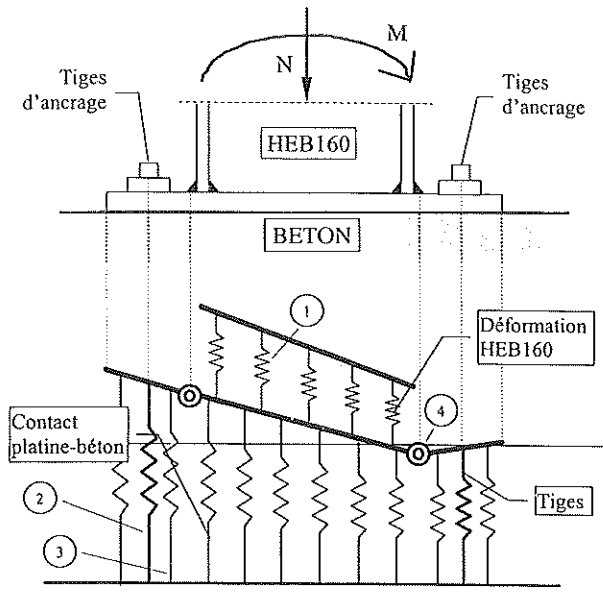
Modélisation des liaisons de pieds de poteaux
